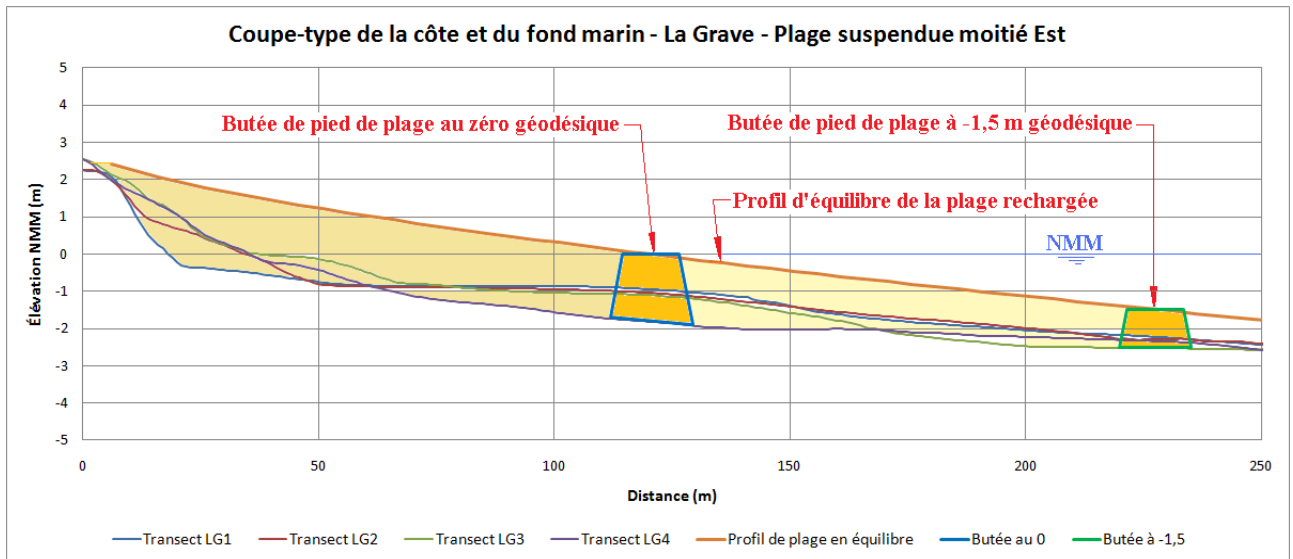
Coupe type d'une plage suspendue devant la plage de La Grave – partie est
